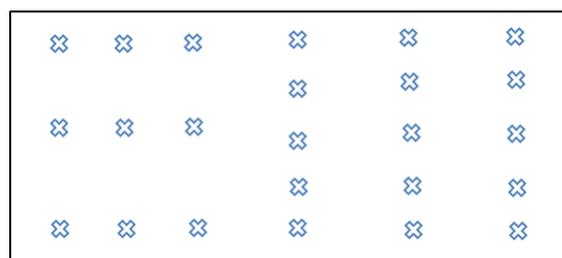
Denah Pencahayaan Gedung Blockboard
